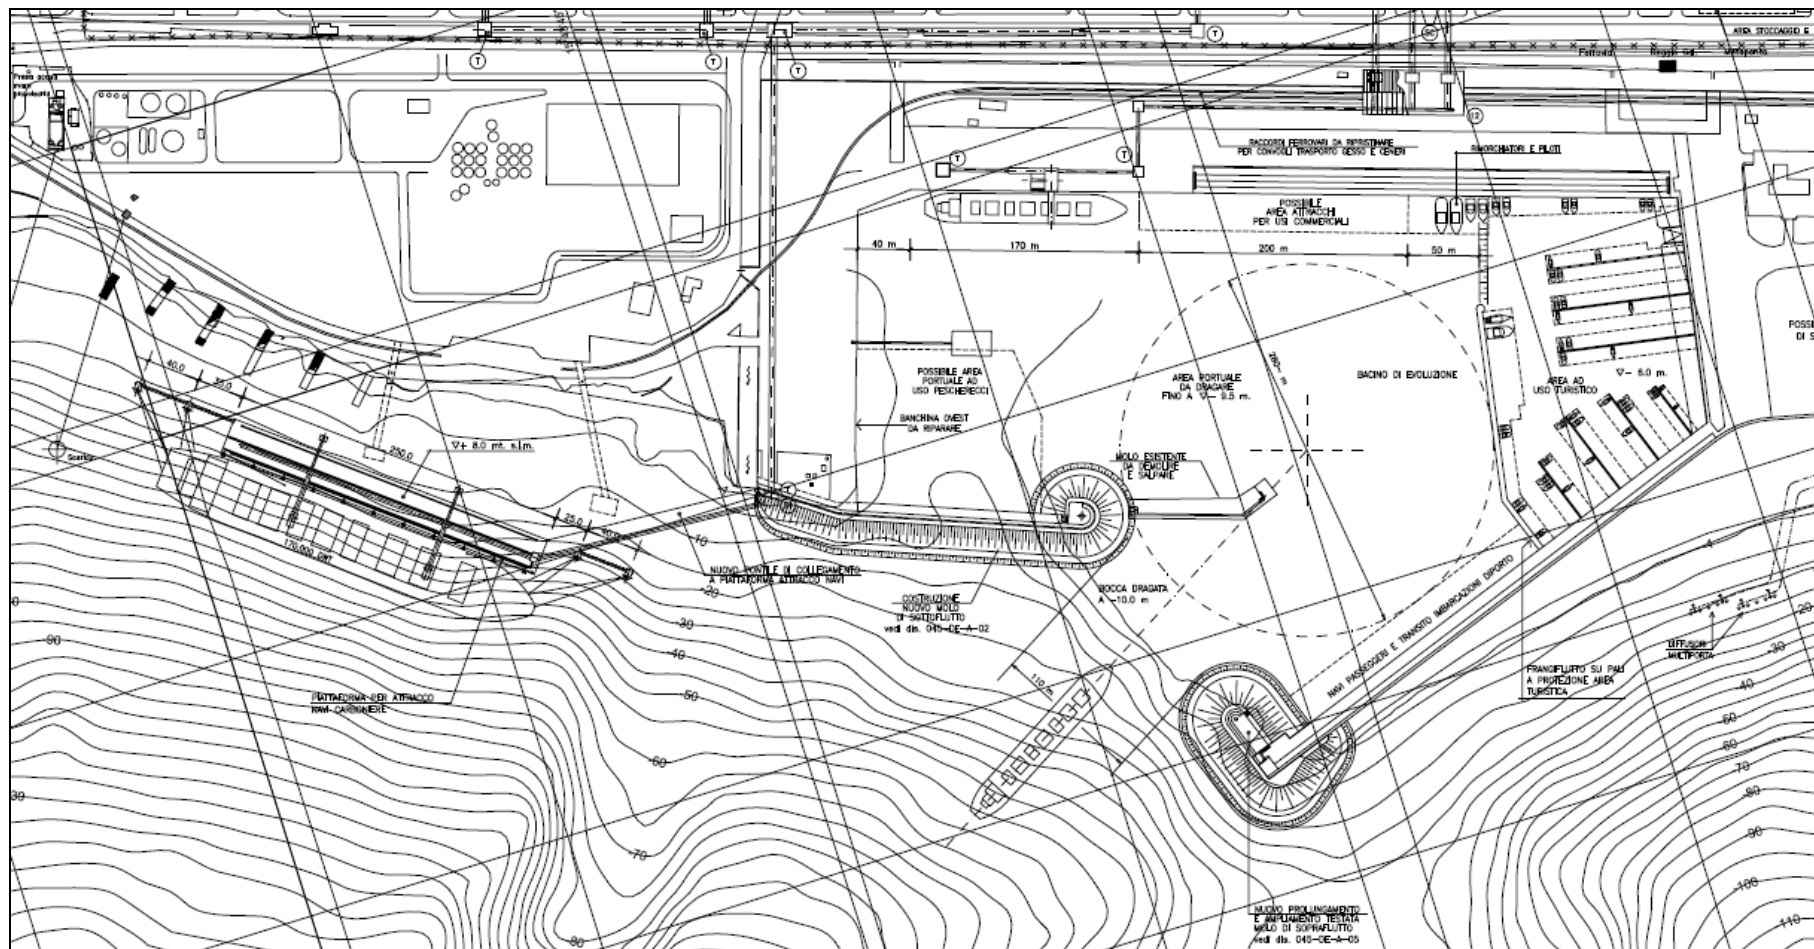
Saline Joniche – Planimetria generale delle opere portuali (Estratto dalla Tavola di Progetto n. 045_00-DE-A-01)
